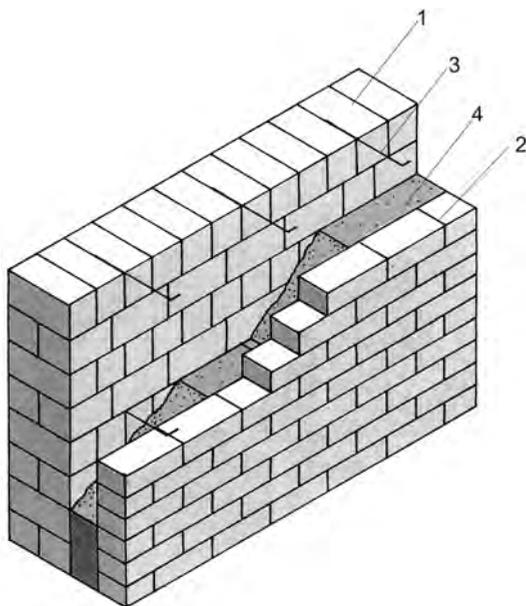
Теплоизоляция в двойной наружной стене: 1 — внутренний слой кладки; 2 — наружный слой кладки; 3 — металлические анкеры; 4 — сыпучий утеплитель
